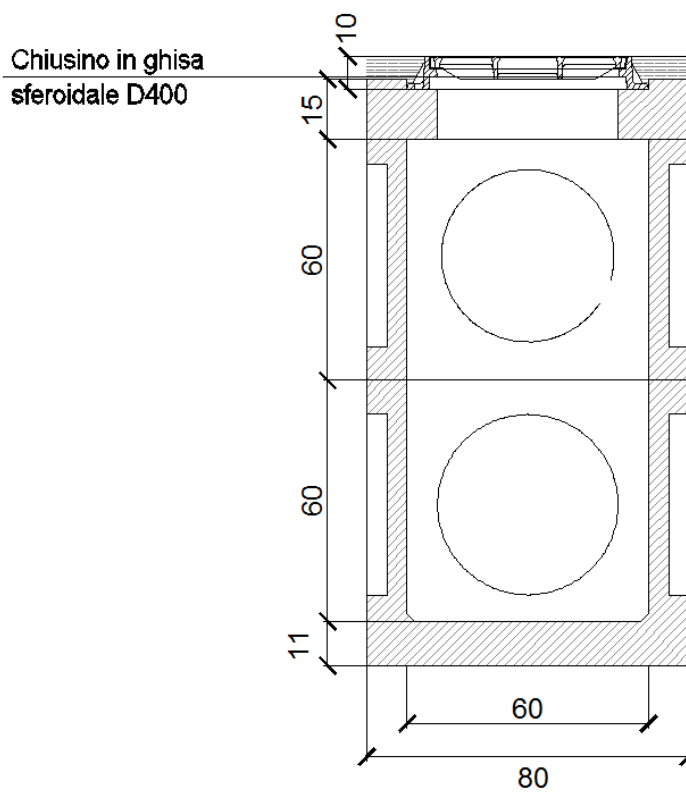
Particolare idraulico - Pozzetto di bypass 60x60
